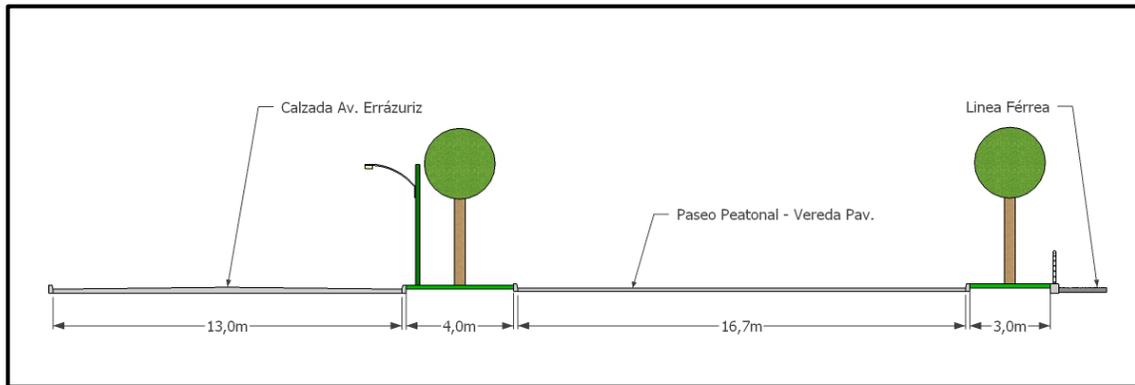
Perfil Transversal Eje E (Av. Brasil) / Sector E1
